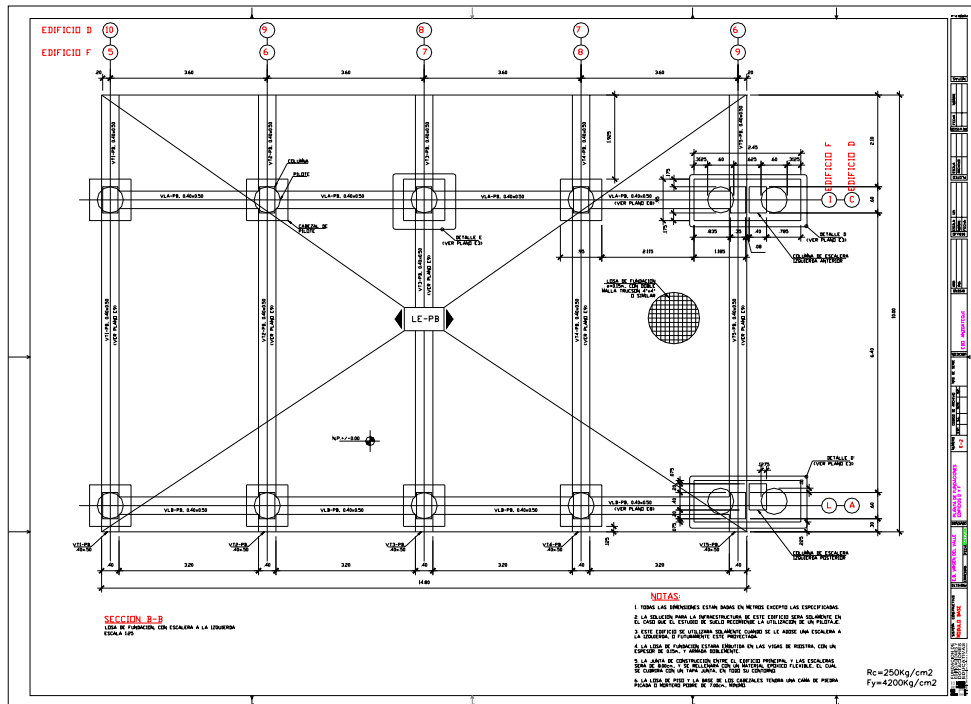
Planta de fundaciones. Modulo de Base.
